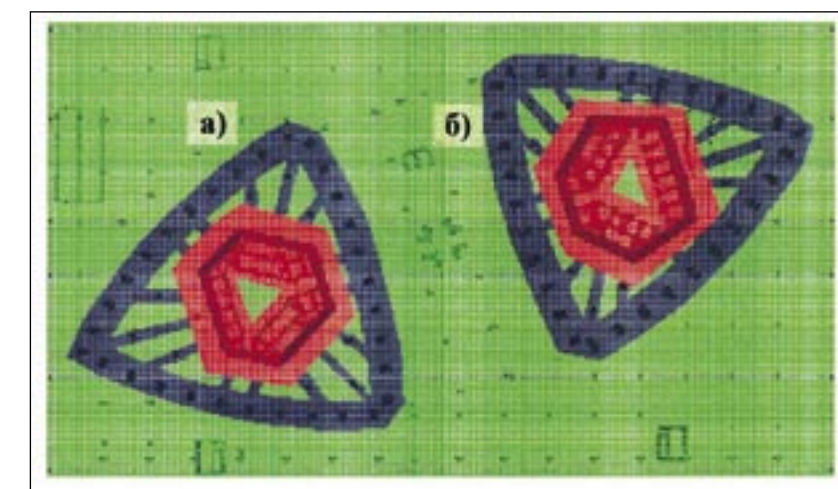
Схема свайных полей под фундаментной плитой: (а) – под башней «Б», (б) – под башней «А»
